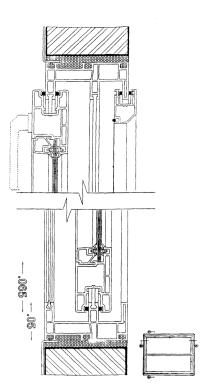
تفاصيل مسقط أفقى لباب بشر انح بلاستيك U.P.V.C
